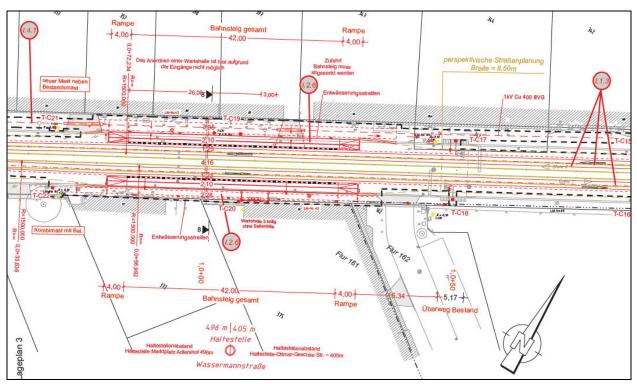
Planungen des künftigen Haltestellenbereichs Wassermannstraße
